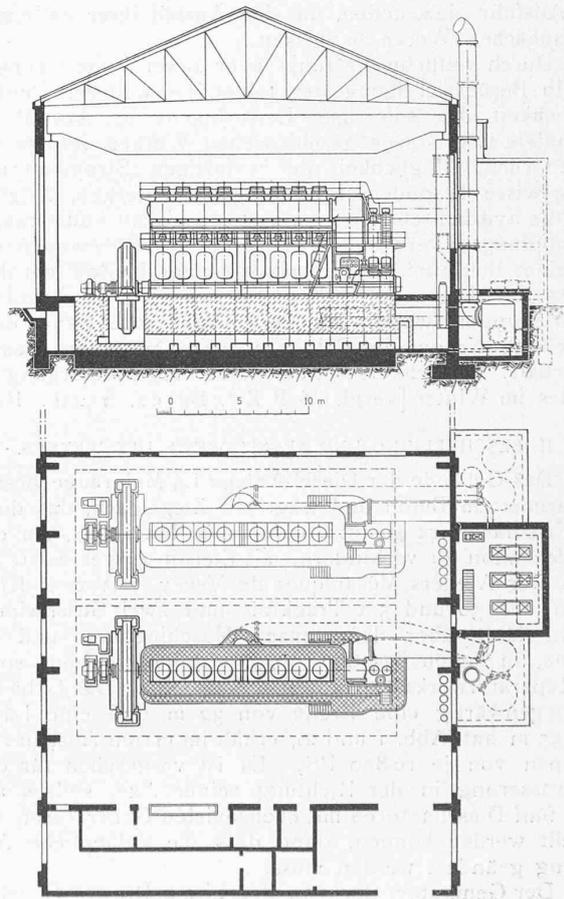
Grundriss und Querschnitt der Zentrale. — Masstab 1 : 500.
